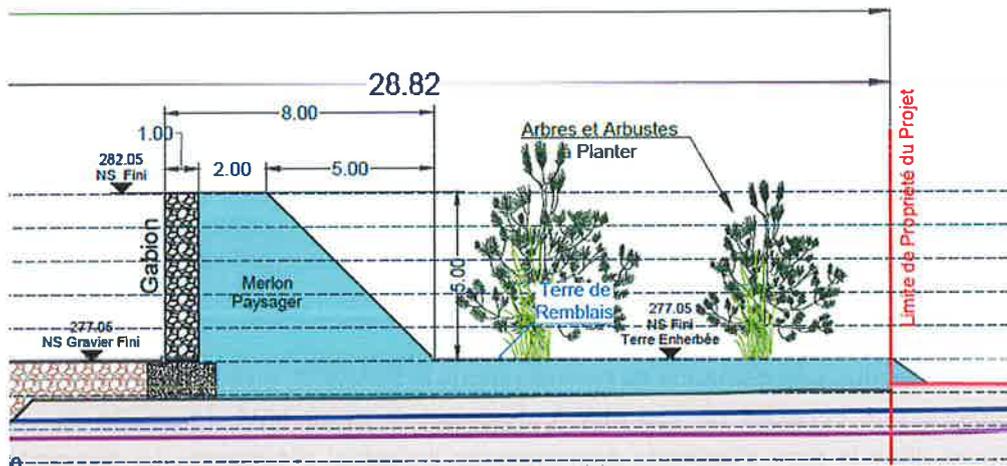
Plan de coupe longitudinale AA avec merlon à 4/4 – dossier de complétude du 09/02/24
